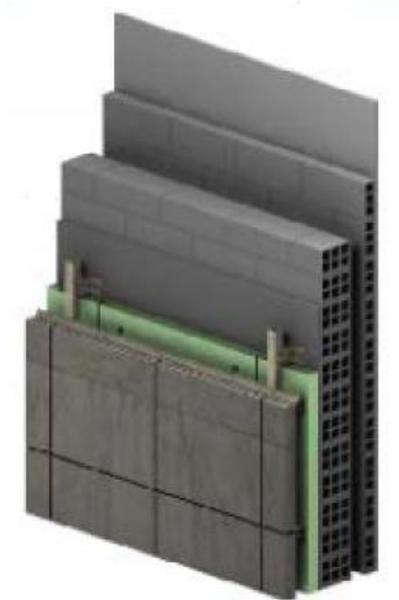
Detalle constructivo de la fachada con aislamiento por el exterior (Catálogo de sol. de reh. Del IVE).
